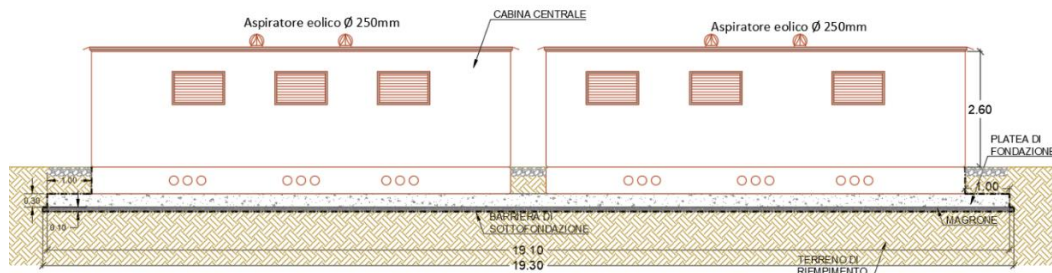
Prospetto retro con platea di Fondazione della Cabina di Centrale
